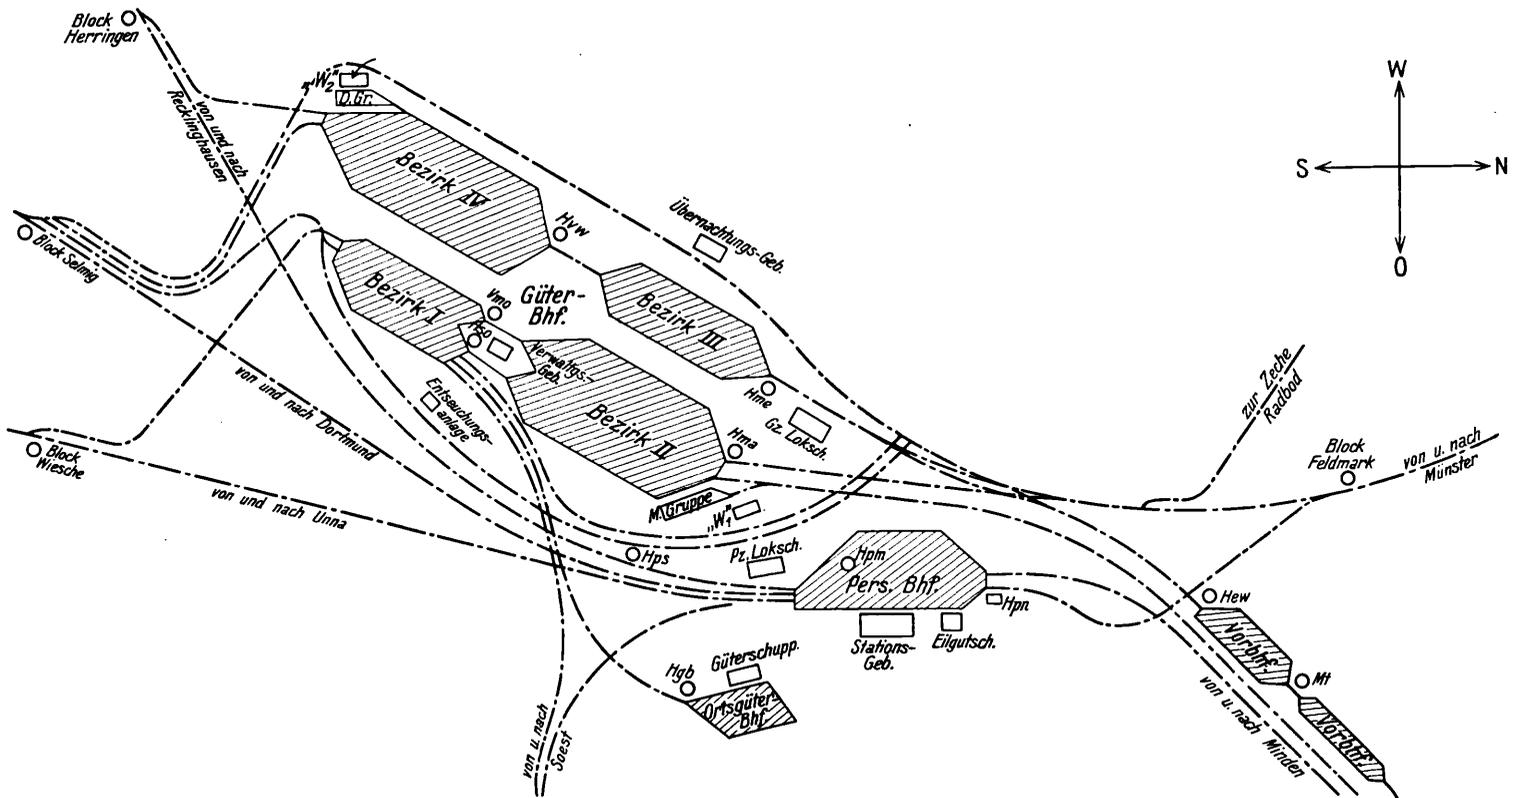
Lageplan des Bahnhofs Hamm i. Westf.
